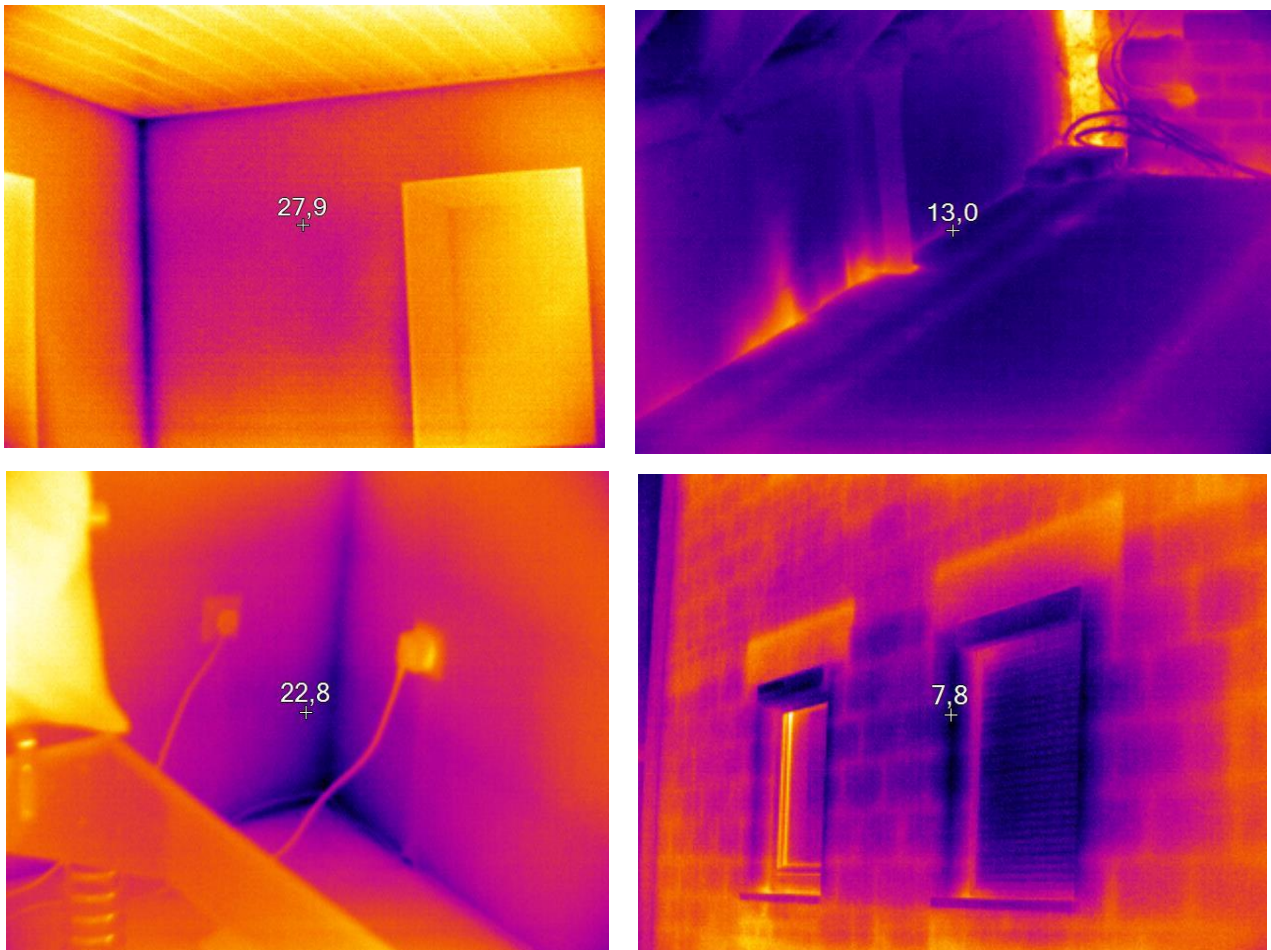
Luftundichtigkeiten oberste Geschossdecke, Wärmebrücke Rollokasten, Wandecke
